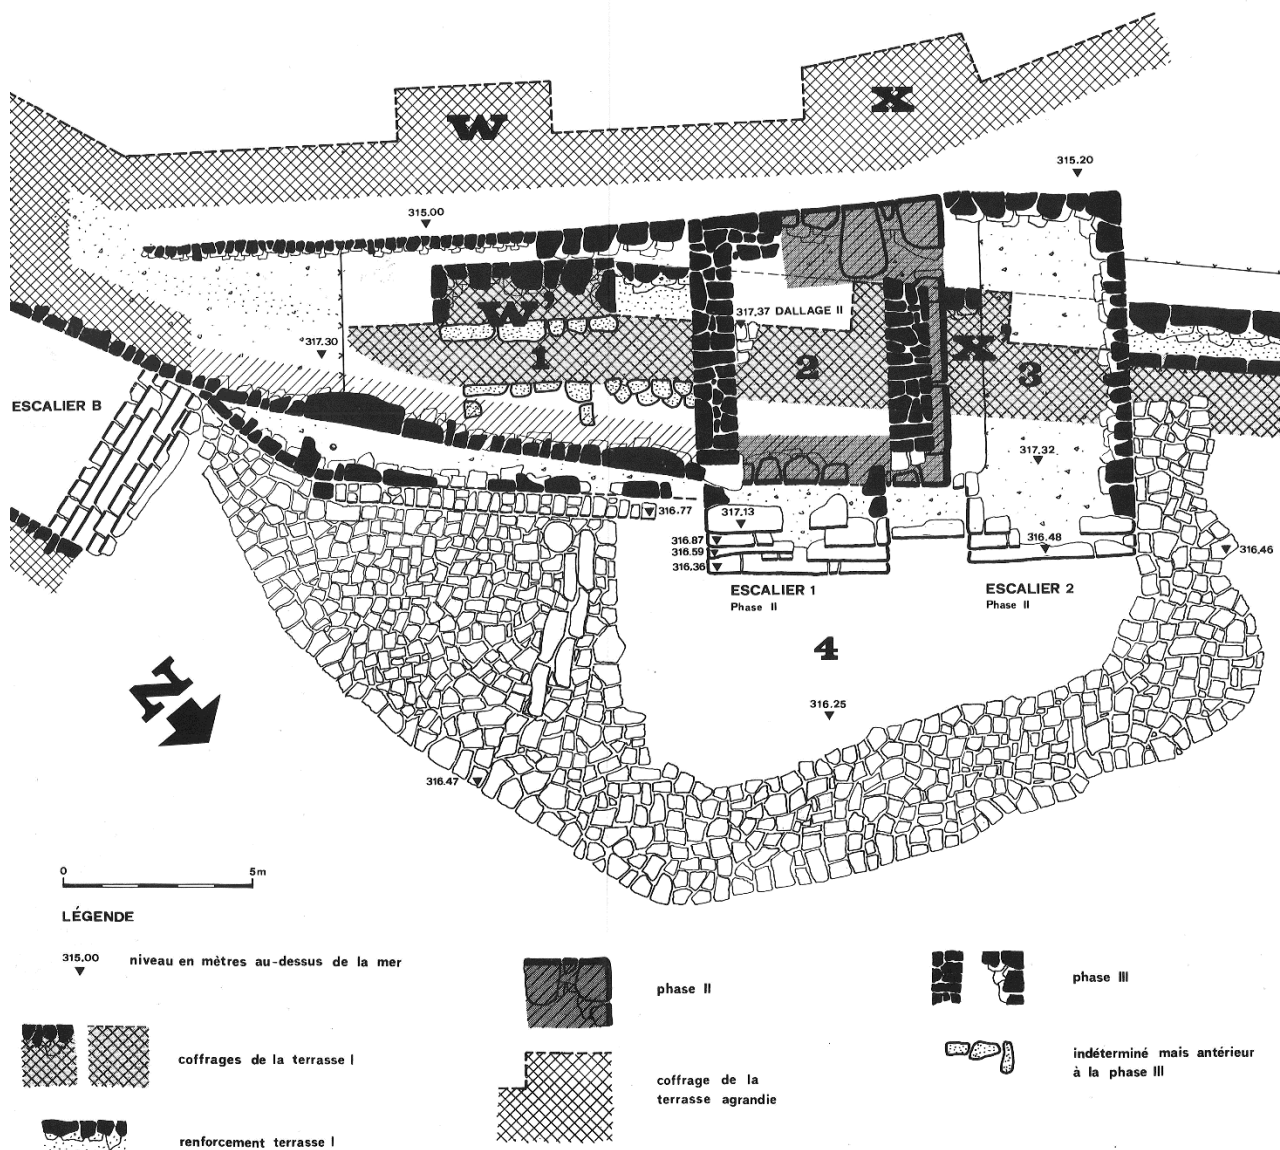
Masjed-e Soleimān, Terrazza I, Pianta dell'area occupata dal podio. Da Ghirshman 1976, Plan VI.
